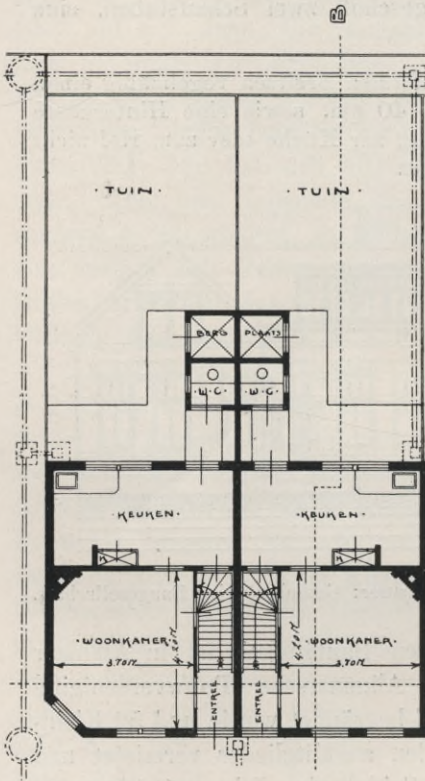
Kleinhausanlage, Grundriß zu Abb. 79, Erdgeschoß.
